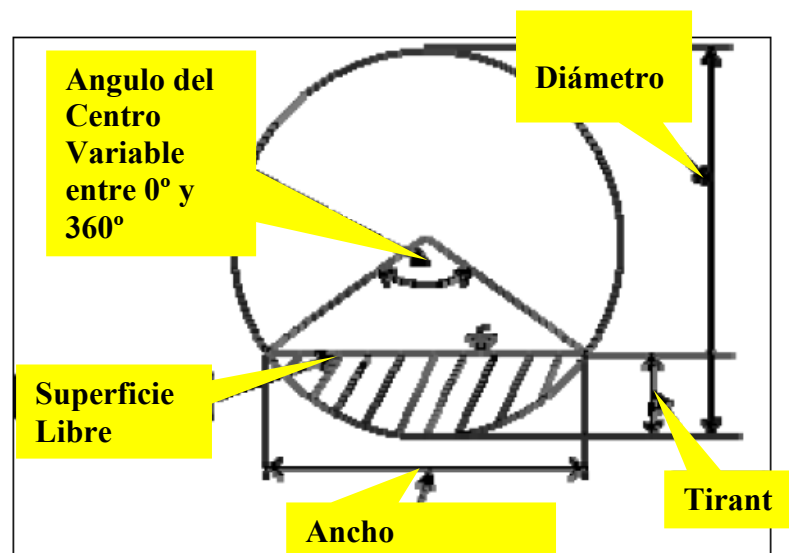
Sección transversal de las alcantarillas y variables de diseño
